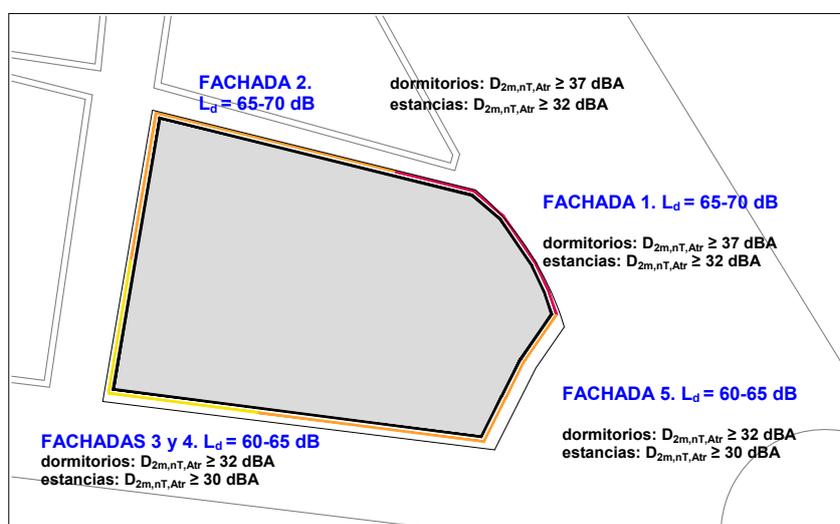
Niveles de ruido de cada fachada y aislamiento acústico necesario en cada fachada.
